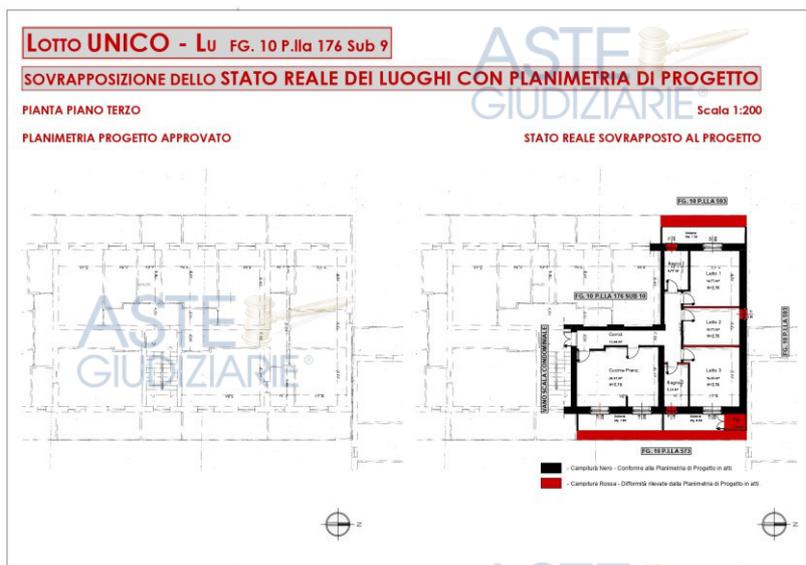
Sovrapp. Stato Reale dei Luoghi/Progetto Autorizzato Lotto U - Lu PIANO TERZO (ALL. 10).
